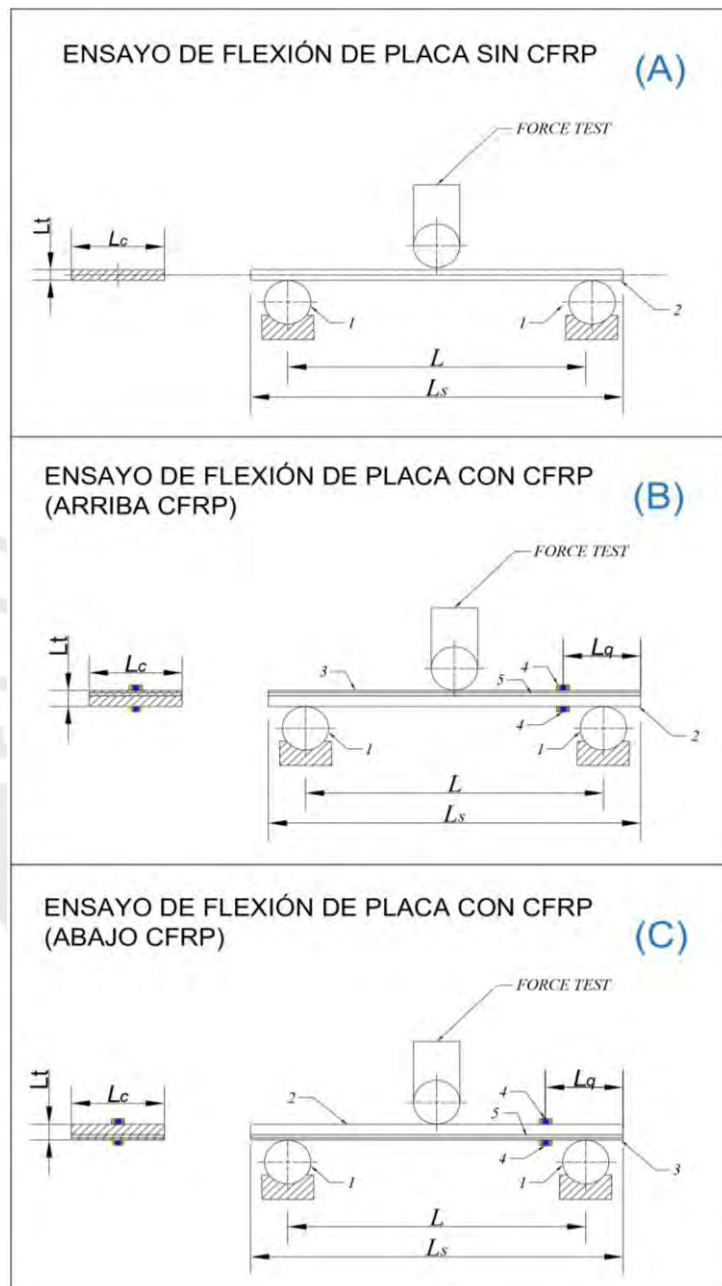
Configuraciones del ensayo de flexión de las probetas. Fuerza del ensayo de flexión, 1. Rodillos de los soportes, 2. Placa de acero A36 3mm, 3. Placa de CFRP S512, 4. Galga extensiométrica, 5. Adhesivo sikadur-30.
